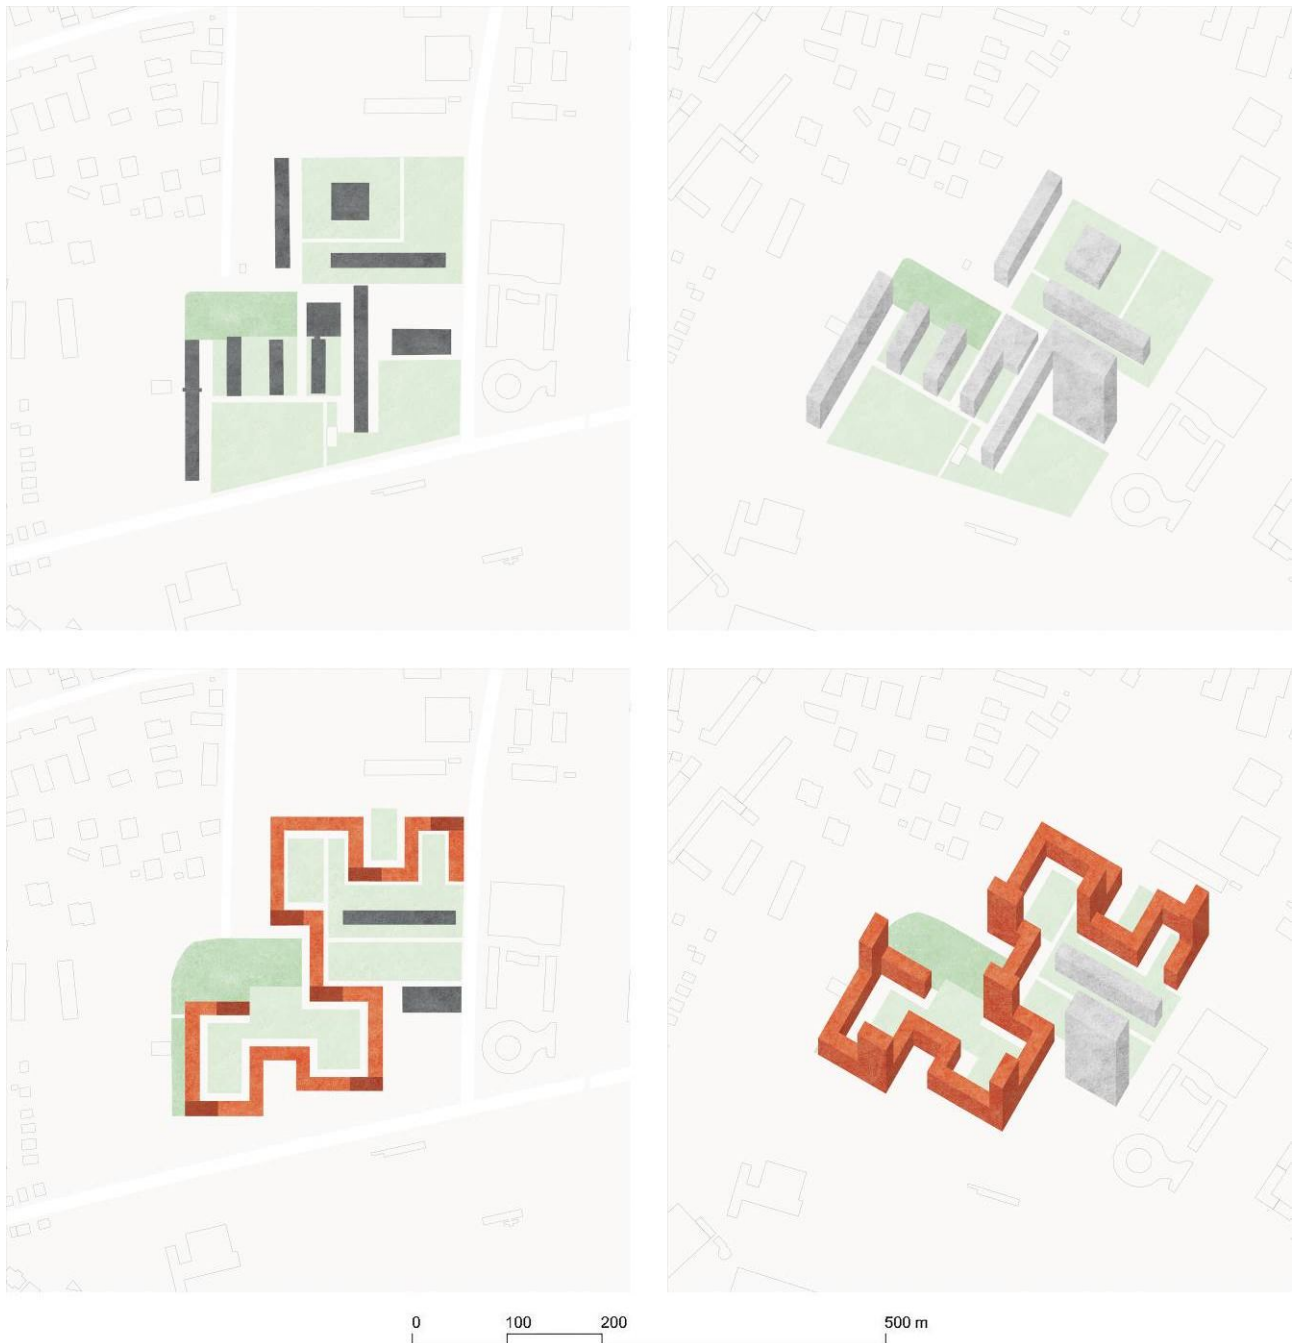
Rapp+Rapp Architekten, *Hoffmanhöfe* (Monaco di Baviera): planimetria e assonometria dell'ensemble allo stato di fatto e di progetto.
